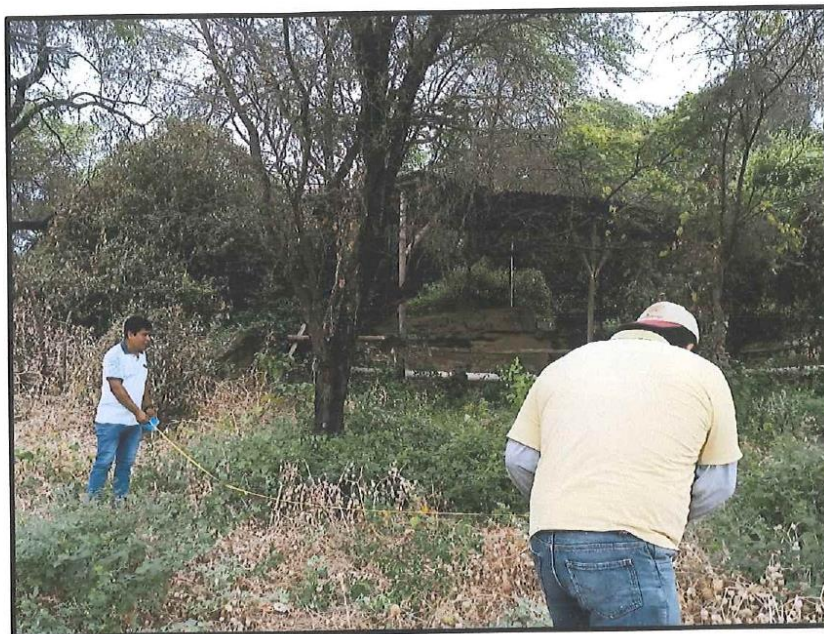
Proyeccion de canaleta de drenaje, con tuberia pvc de diametro 4"
